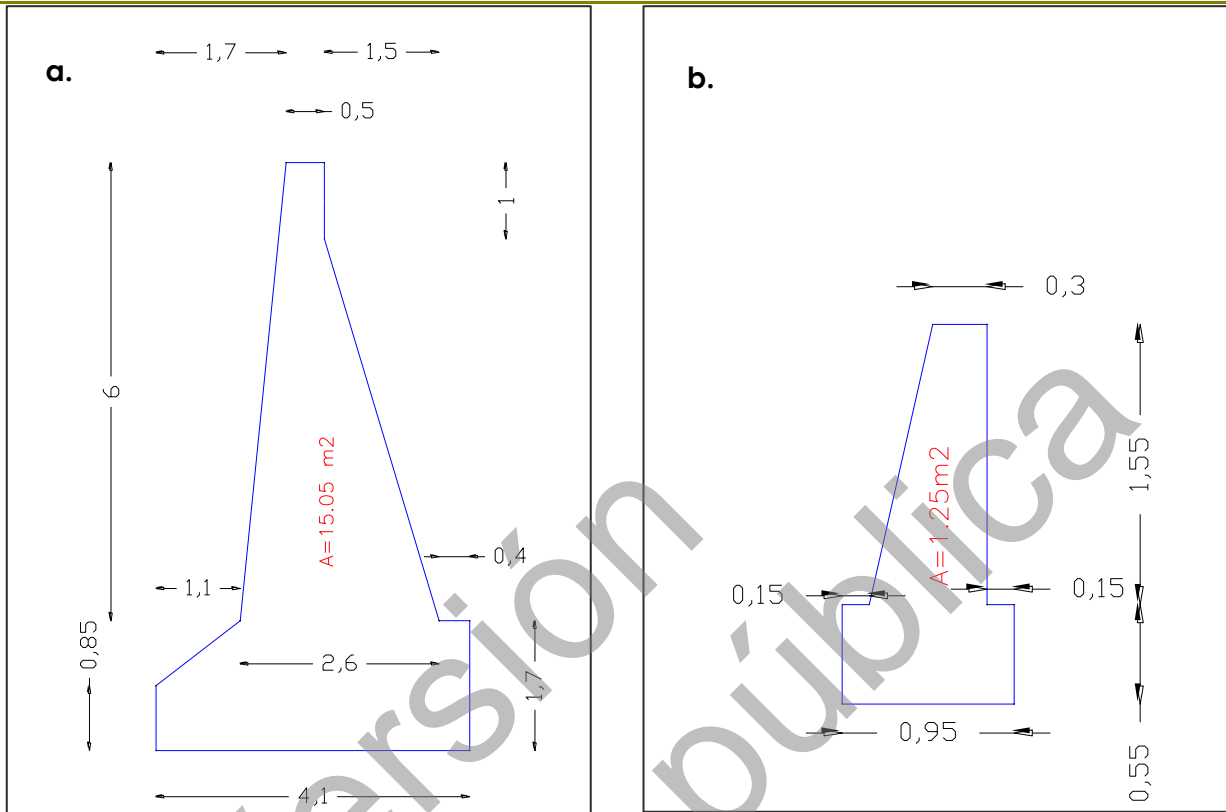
Esquemas constructivos de muros de contención (a. 12 m y b. 22 m de longitud).
